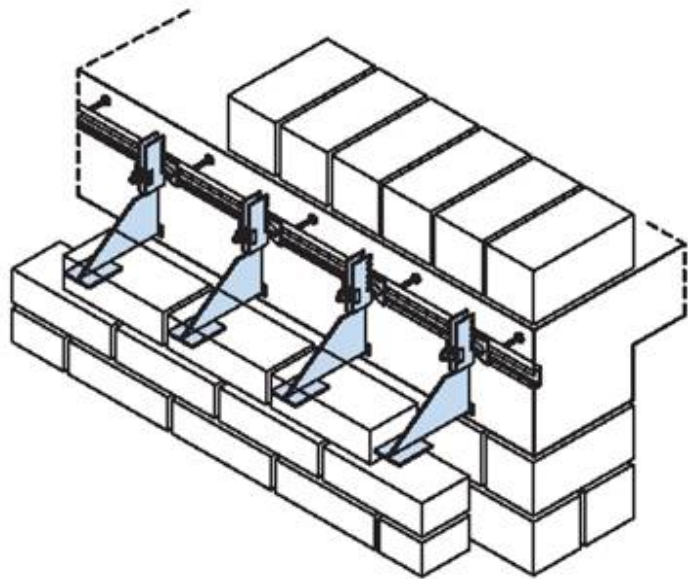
Sistema estándar centroeuropeo "Halfen HK4", de ménsulas de apoyo de la hoja exterior, ancladas a una guía previamente empotrada en el hormigón armado, donde se disponen las ménsulas de apoyo de cada ladrillo.
